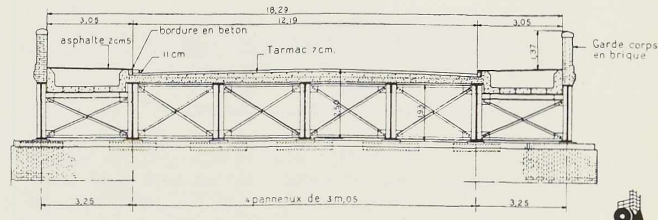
Coupe transversale du pont-route de la fig. 367.
